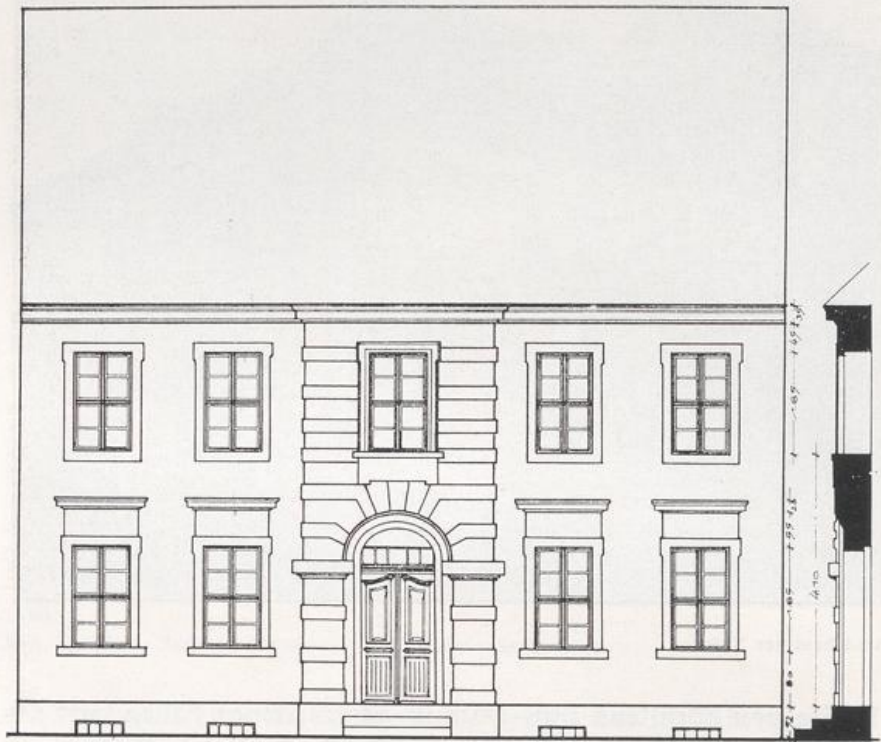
Haus Kommissionsstraße 7 nach Brauchs Entwurf
